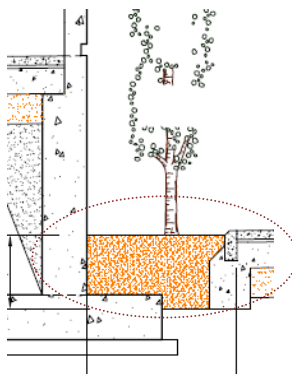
Plànol 14 full 3 Secció núm.3 – detall tipus jardinera-mur.
